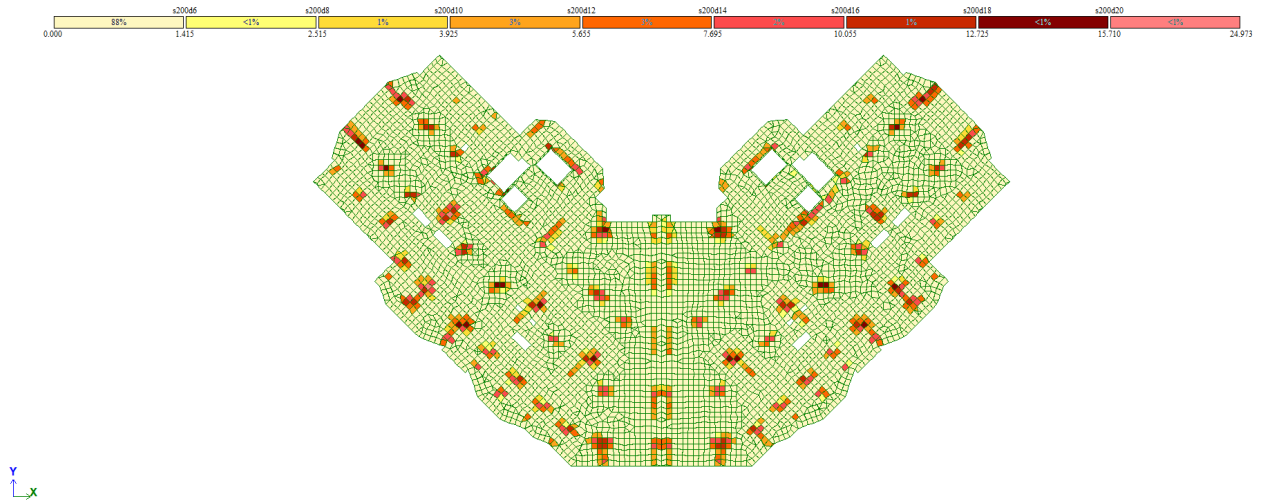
Площа арматури плити на 1 м. п. по осі y (верхня грань)
